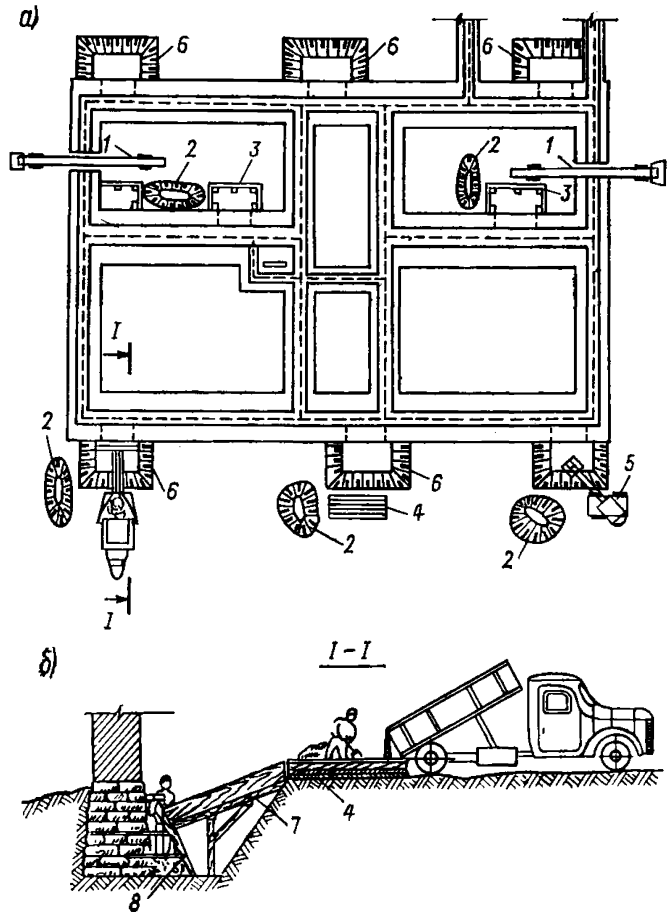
Общая схема организации работ по усилению бутовых ленточных фундаментов с увеличением площади подошвы
